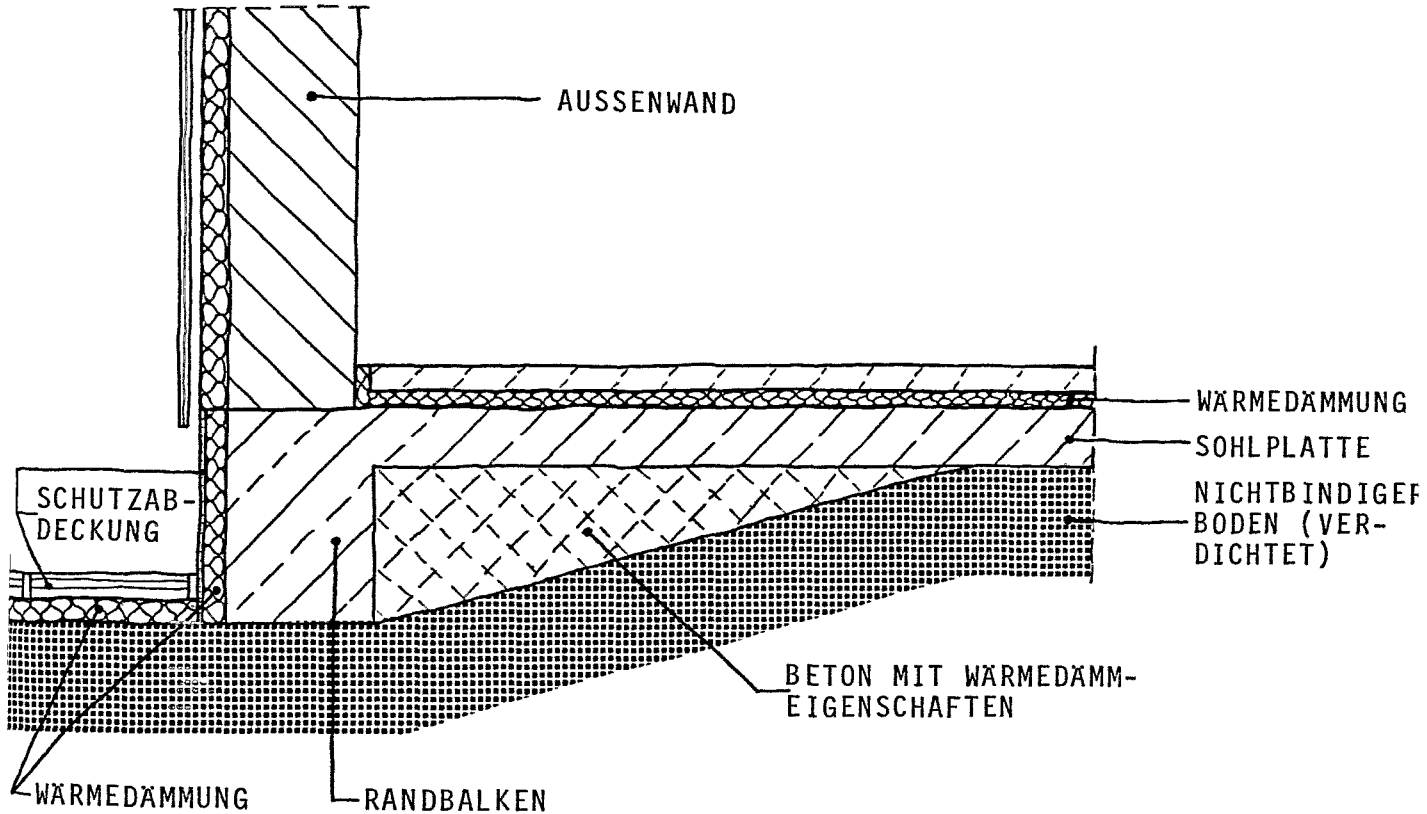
Stahlbetonsohlplatte mit Wärmedämmung auf der Innen- und Außenseite
